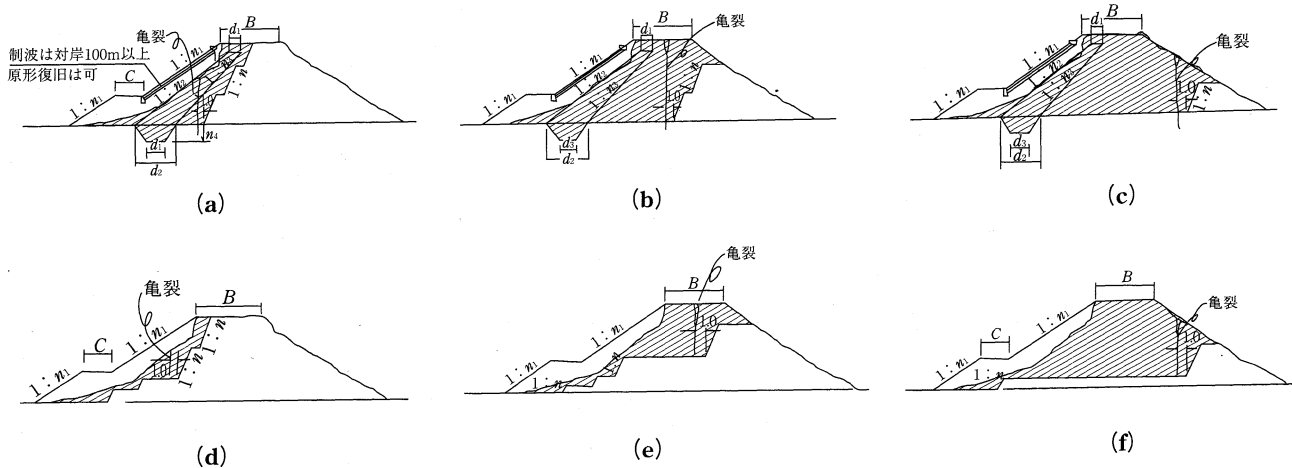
堤体の復旧図 (縦断亀裂)¹⁾
